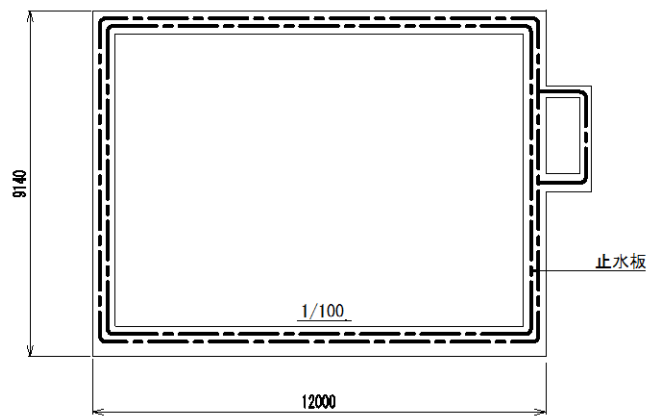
(4) 復水貯蔵タンク遮蔽壁 概略配筋図 (弁室)
